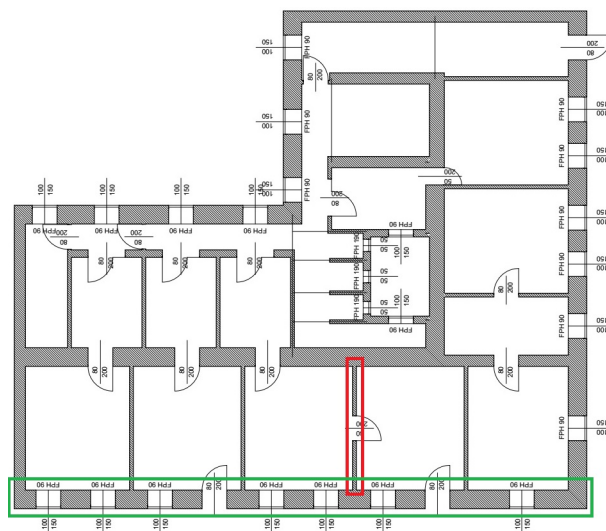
gewählter Grundriss mit Abschnitt für Wand in Rot und Pfeiler in Grün
